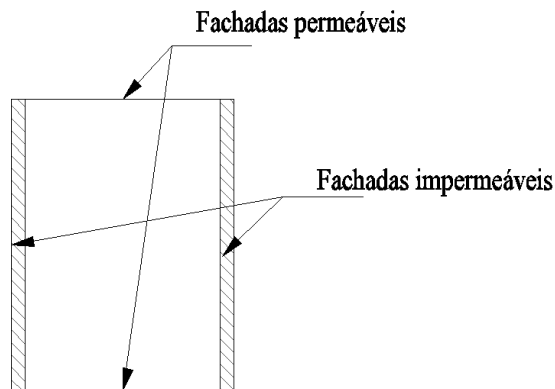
Identificação das fachadas permeáveis e impermeáveis na situação 1
